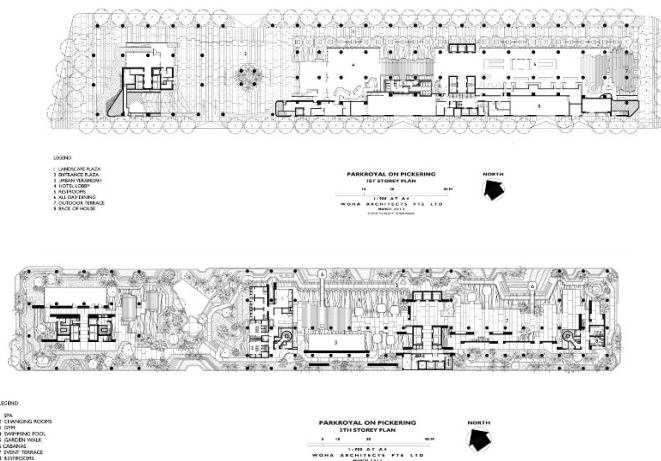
План 1го и 5го этажей отеля ParkRoyal
